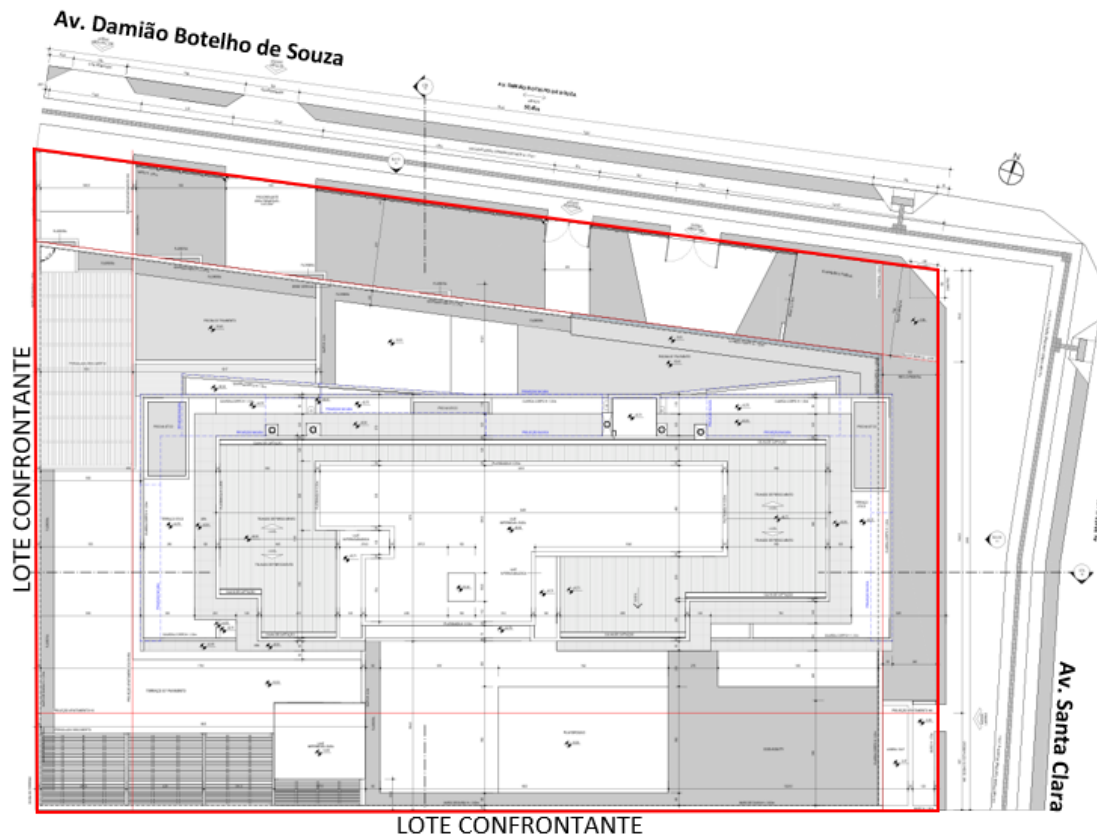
Implantação. Fonte: Projeto Simplificado: Habitação Coletiva, 2024, editado por SYDOR arquitetura, 2024.
